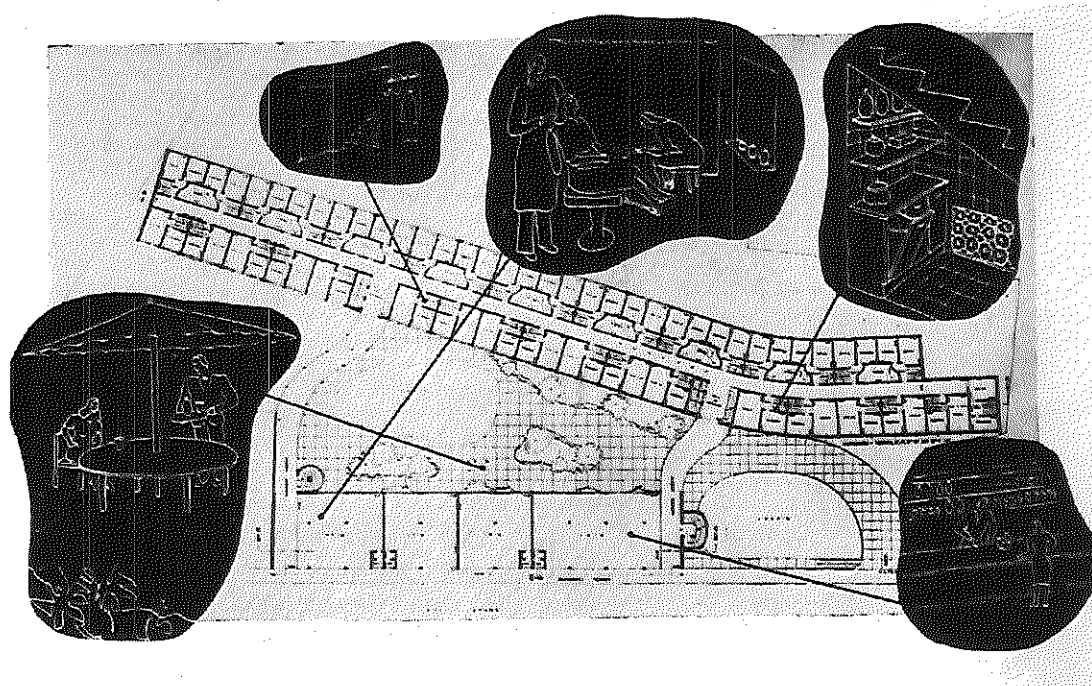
Planta do andar tipo 01 - Conjunto Japurá
